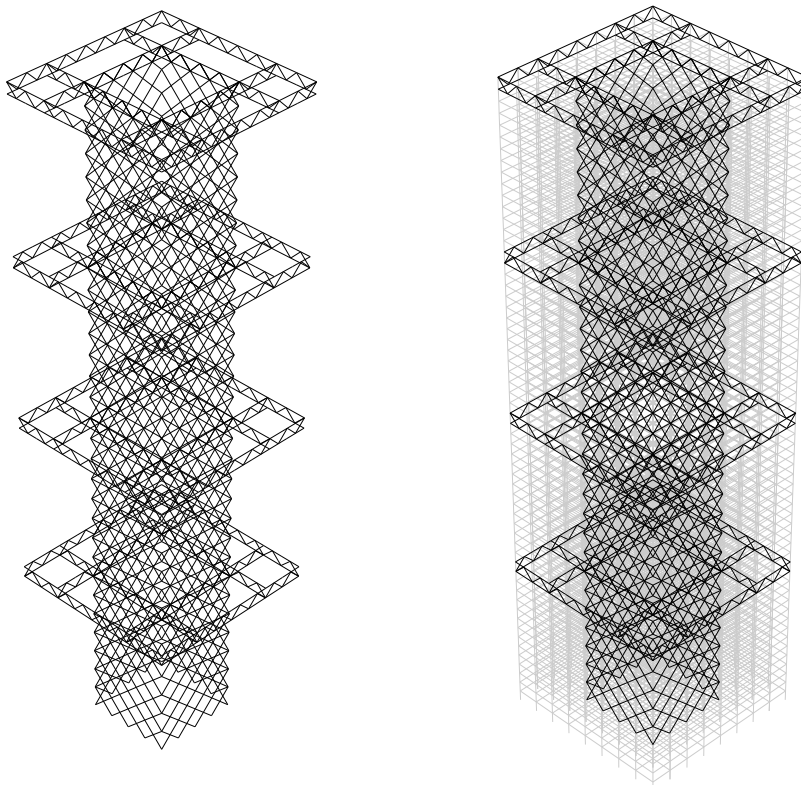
rappresentazione schematica della struttura tridimensionale dell'Edificio 4.
